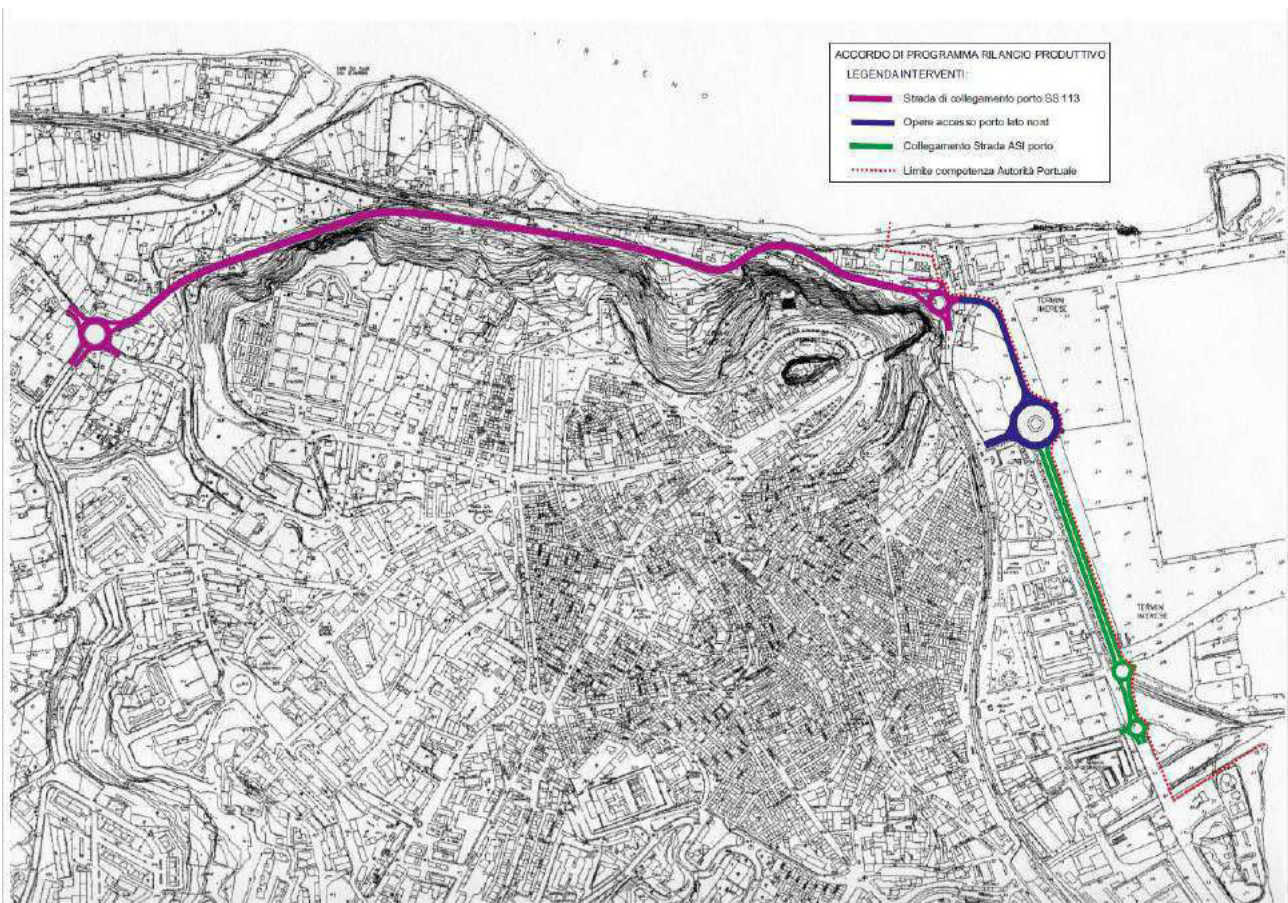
Strada di collegamento tra il Porto di Termini Imerese e la SS 113 (Fonte: SIS)
